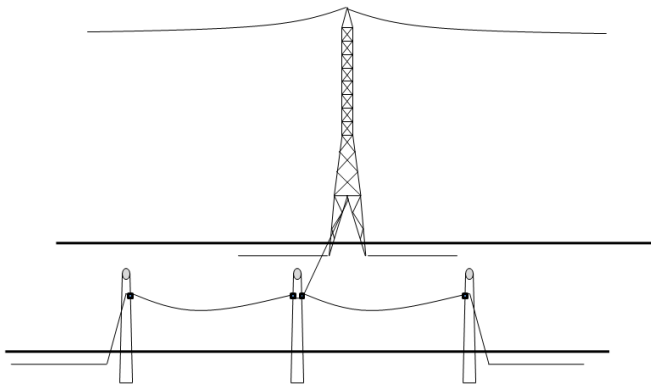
Aterramento de torre com cabo contrapeso alternativo utilizando postes de concreto na borda da faixa de servidão.
